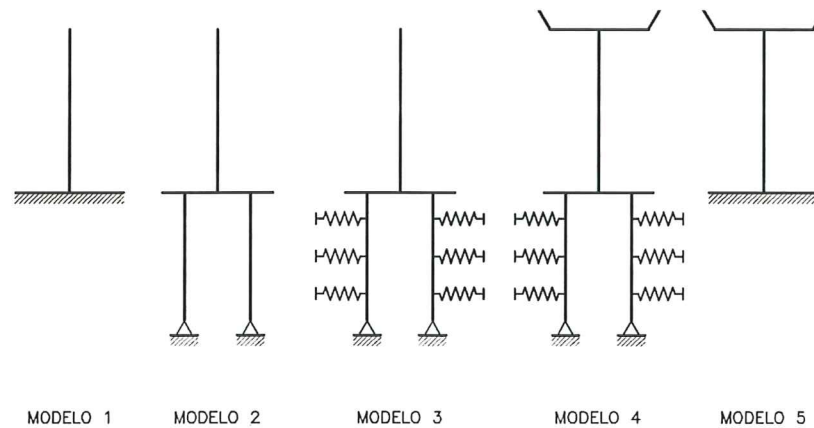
Modelos posibles de una pila de hormigón armado (Elnashai, 1996).
